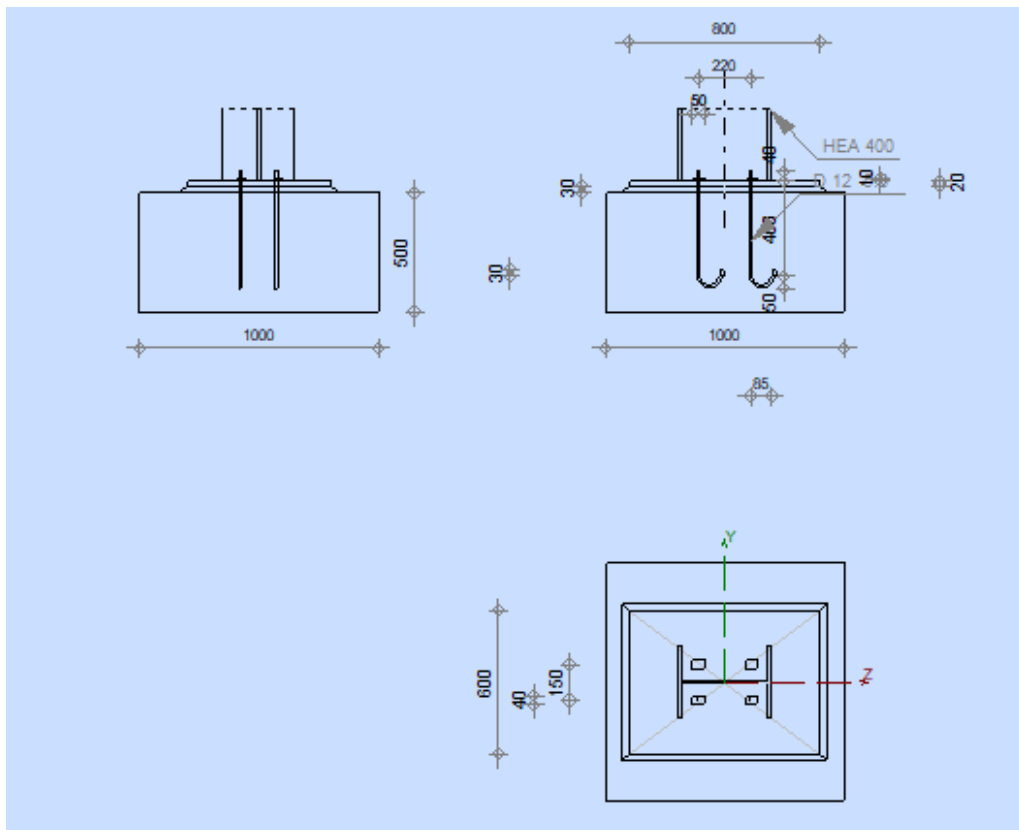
« Schéma d'assemblage pied de poteau fait par Robot »
